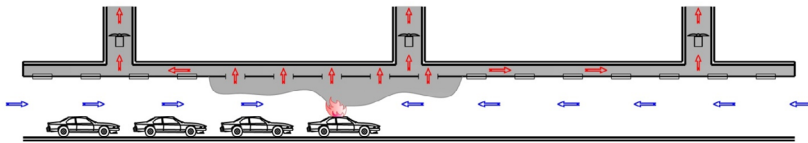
Продольно-поперечная схема противодымной вентиляции
